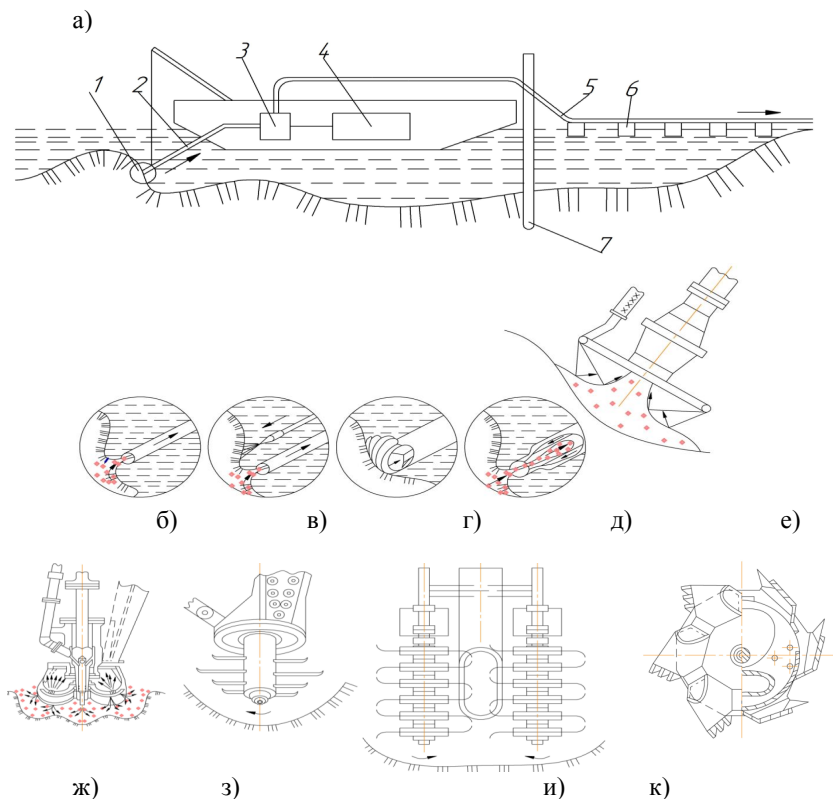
Схемы: а – принципиальная схема земснаряда; б...к – принципиальные схемы всасывающих, разрыхляющих грунтозаборных устройств: б – свободно всасывающего наконечника; в – грунтоприёмника с гидромонитором; г – грунтоприёмника с фрезерным рыхлителем; д – гидрозжекторного грунтоприёмника; е – многосоплового гидравлического рыхлителя с грунтоприёмником; ж– фрезерно-гидравлического рыхлителя с грунтоприёмником; з – винтового; и – ротационного; к – роторно-ковшового рыхлителя; 1 – грунтоприёмник; 2 – рама с всасывающей линией; 3 – землесос (грунтовый насос); 4 – двигатель; 5 – нагнетательный (напорный) пульпопровод; 6 – плавучий пульпопровод на поплавках (плавучих понтонах); 7 – свайный ход.
